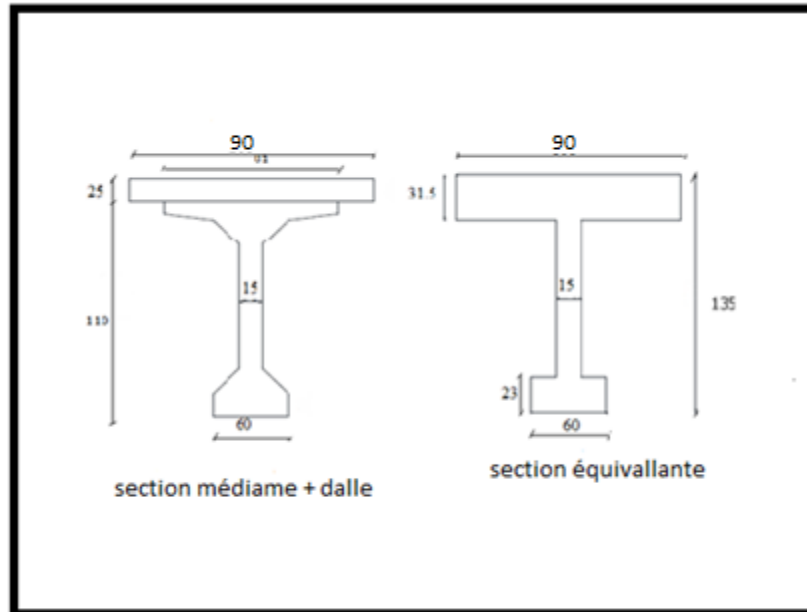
Section équivalente de la section médiane composite (dalle + poutre)
